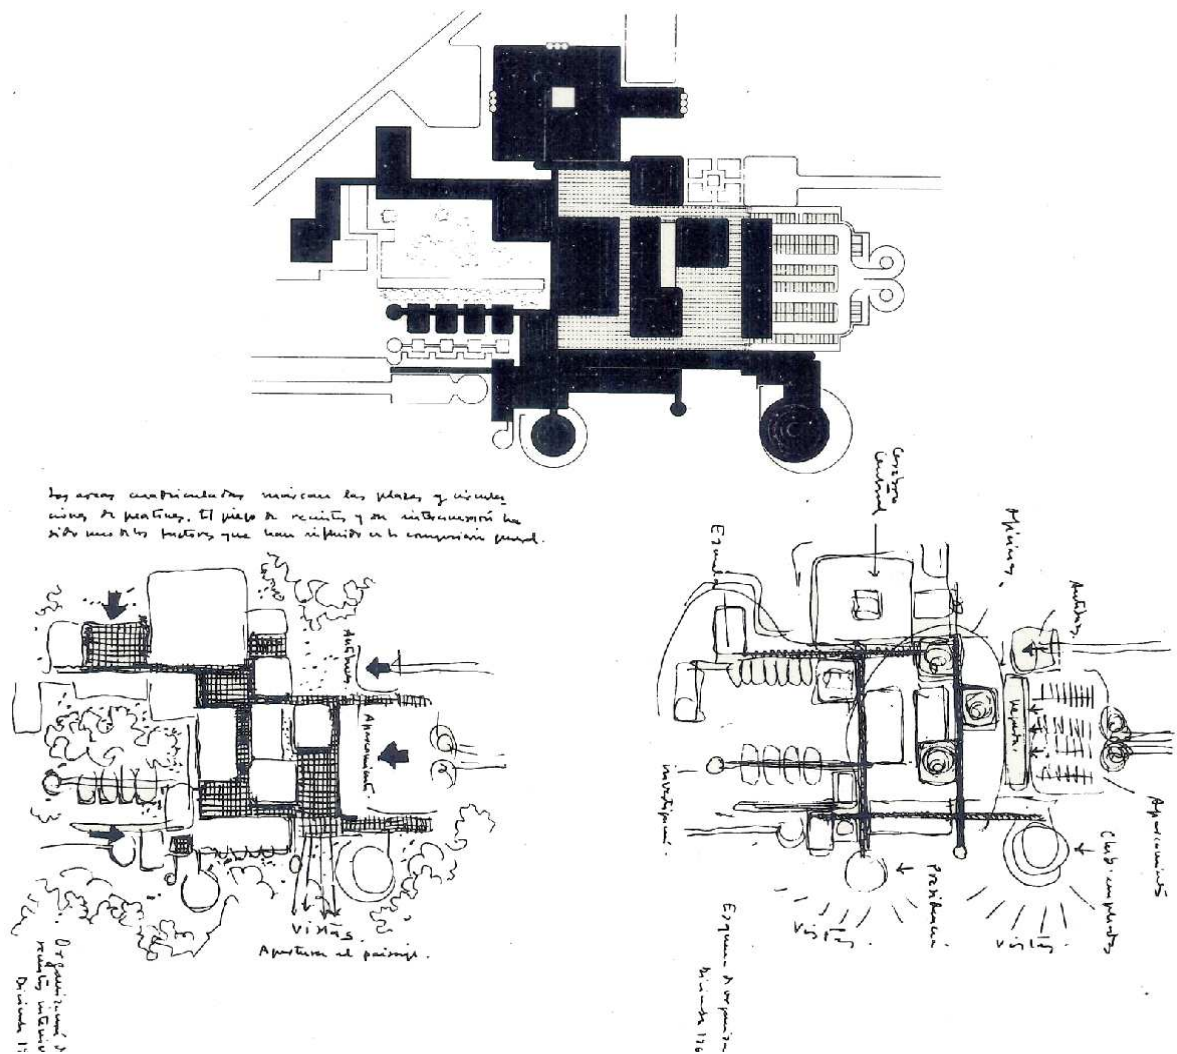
Primer proyecto para la sede no construida de Telefónica en la calle Fuentelarreina, Madrid, 1967, Julio Cano Lasso y Juan Antonio Ridruejo Brieva. (Cano Lasso, 1992, p. 113)
